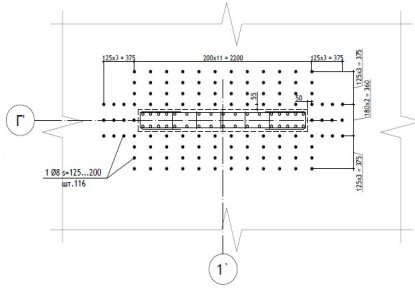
Армуння опорної зони плити вертикальною поперечною стержньовою арматурою
